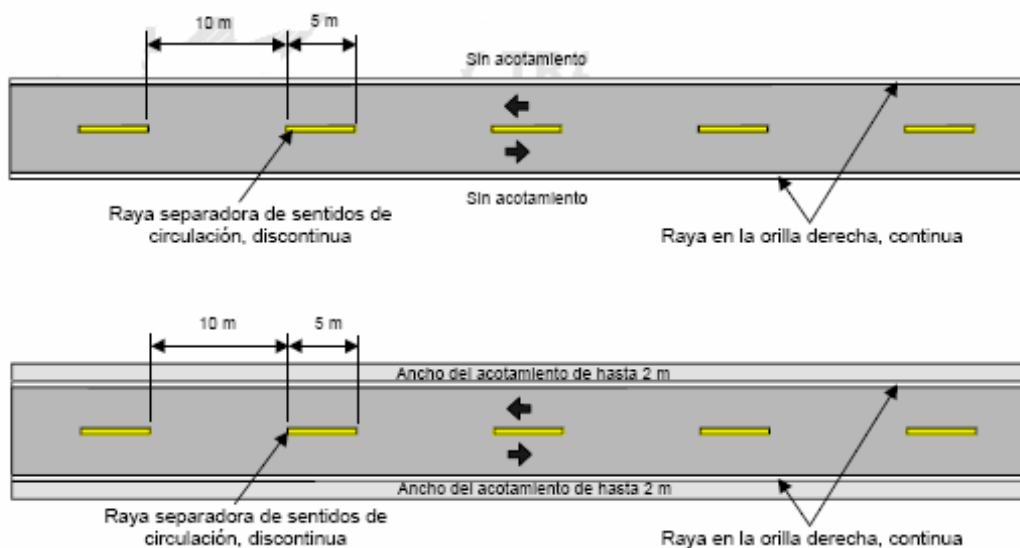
Marcas en el pavimento en carreteras con ancho de calzada de hasta 6.5m.
